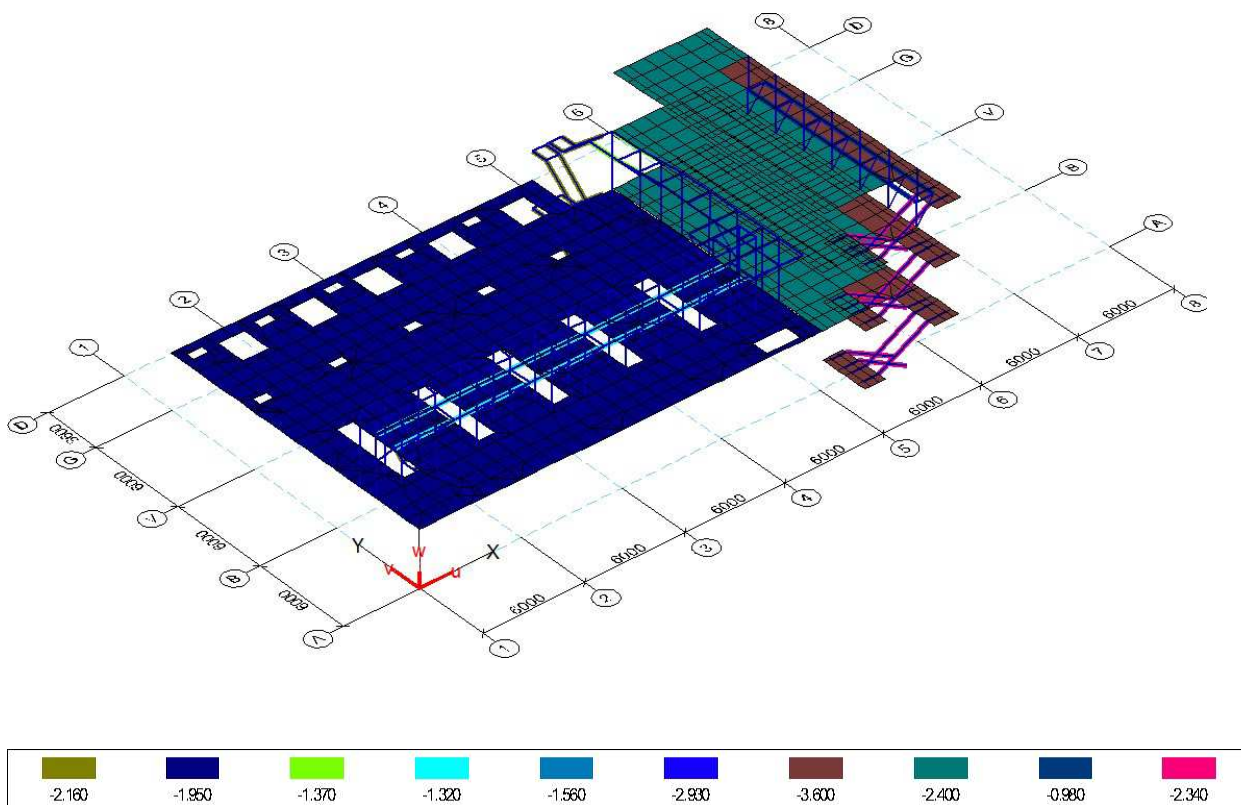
Эксплуатационная нагрузка на перекрытия на от 3,300 до 8,000
